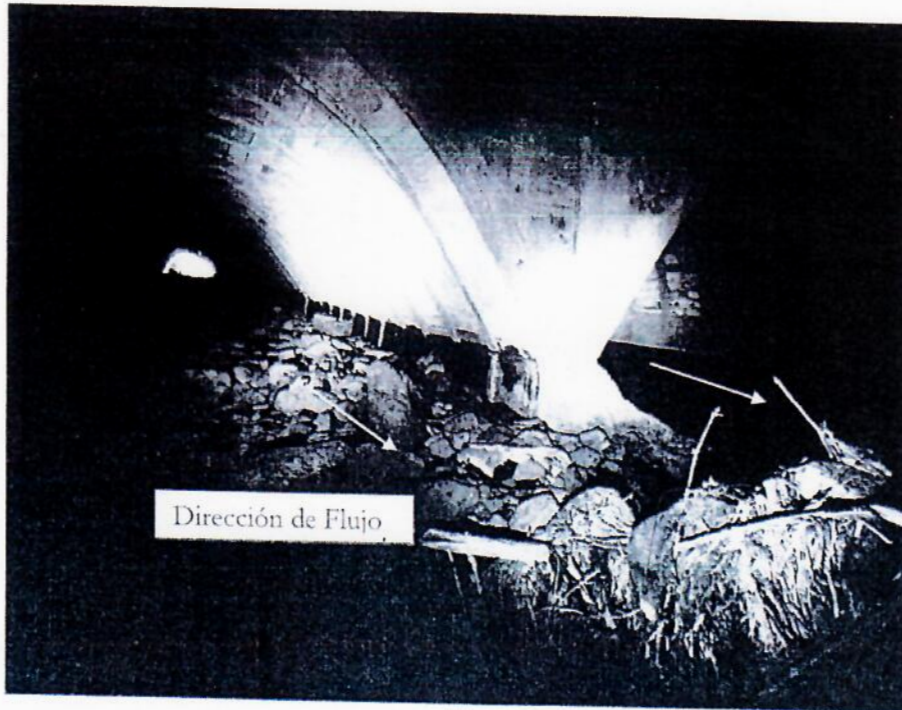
Cambio de sección de bóveda tramo bajo Carretera Panamericana, sección de semi arco.
